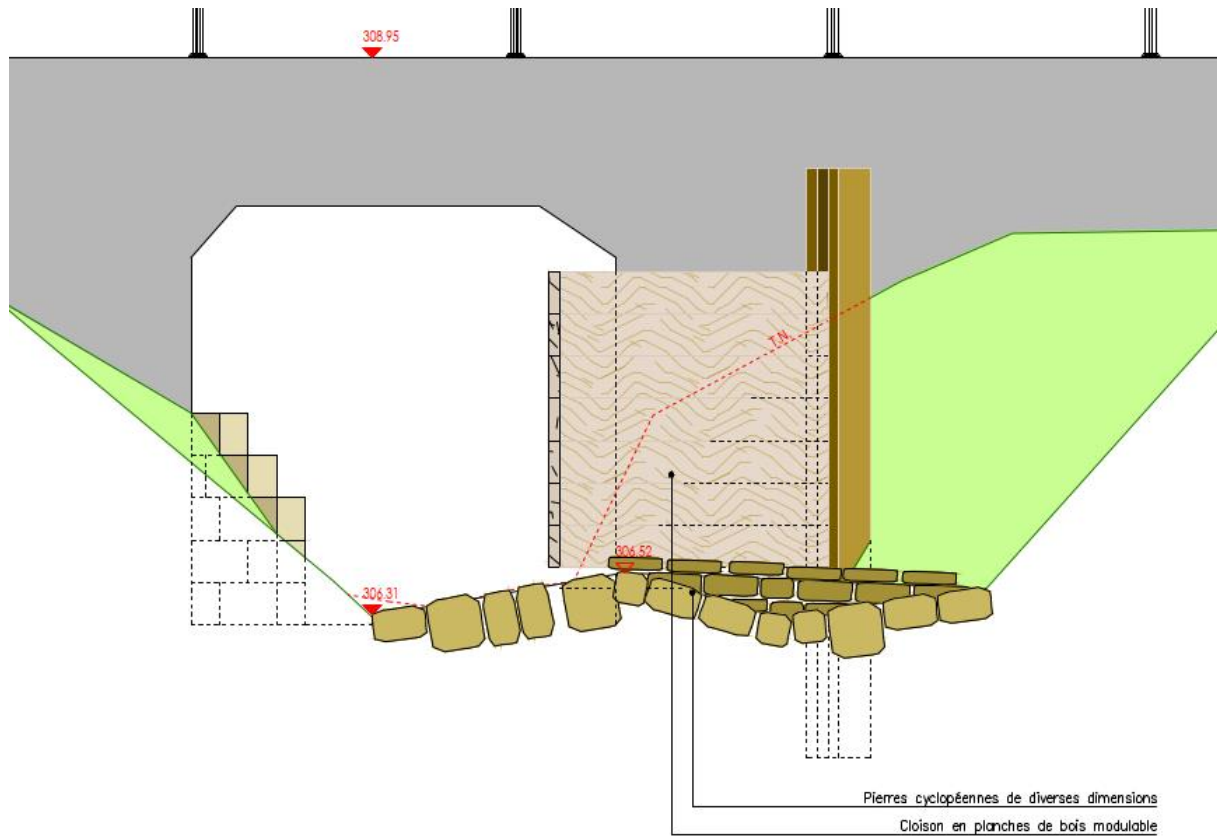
Auszug aus dem veralteten Plan „Concept d'assainissement - Vues en plan et coupes ouvrages“ (Quelle: Luxplan S.A. Stand 06/2020): Querschnitt durch die Ausleitung (Schnitt BB, vgl. Abb. 24)
